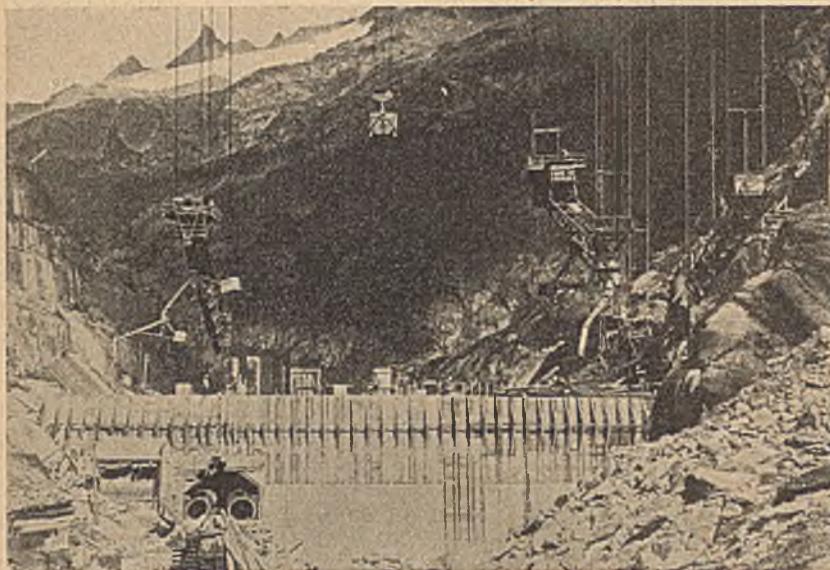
An Seilen hängende Gießbühnen und Arbeitsbühnen bei den Betonierungs- und Verschalungsarbeiten der Spitalamm-Staumauer.
